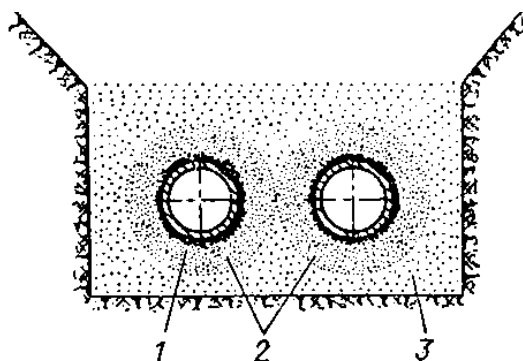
Разрез бесканального теплопровода в самоспекающемся асфальтоизоле:
